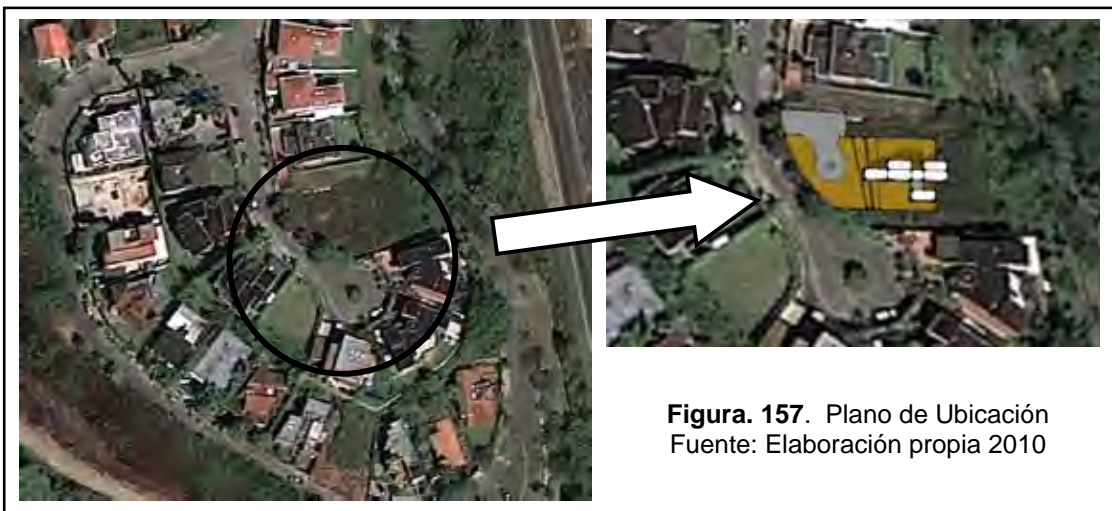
Plano de Ubicación Fuente: Elaboración propia 2010
